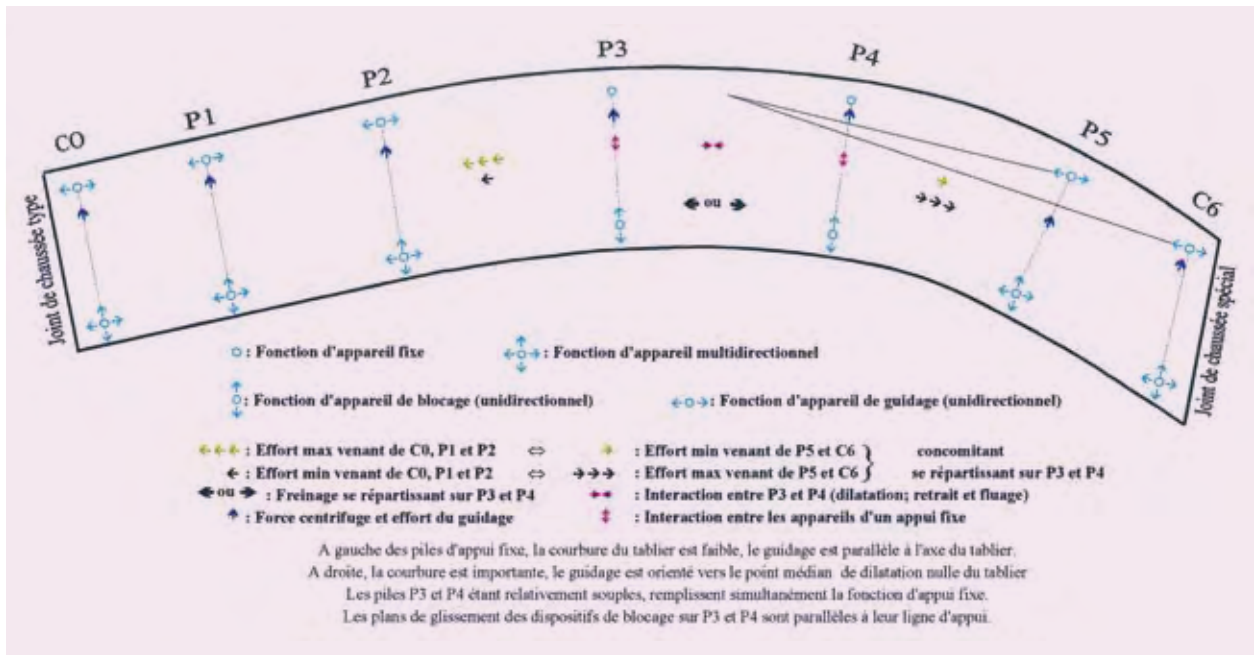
exemple schématique en plan d'une disposition d'appareils d'appui à pot ou d'appareils d'appui sphériques
